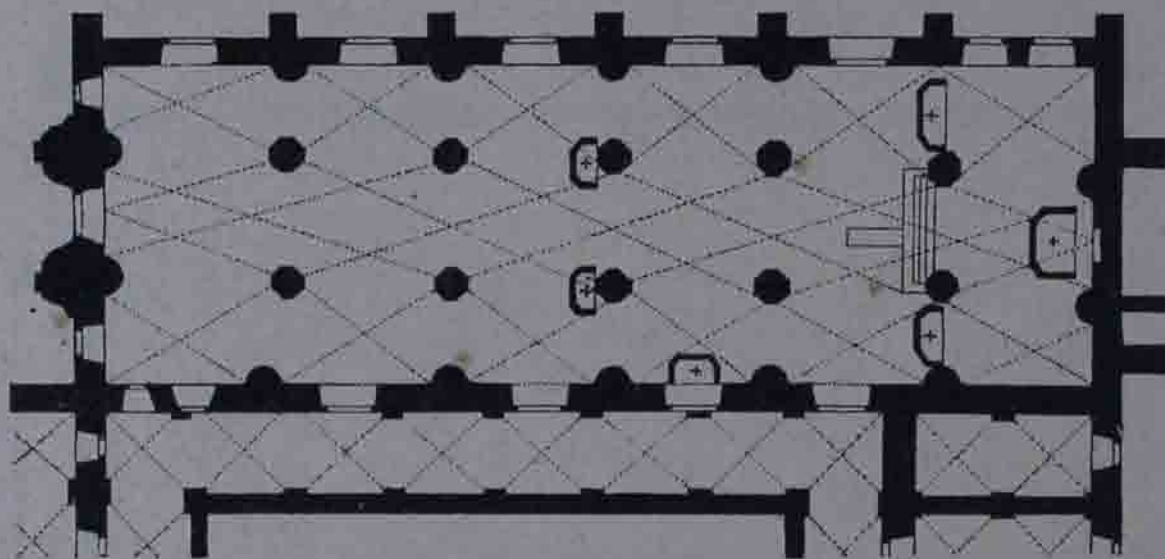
Tulln, ehemalige Dominikanerinnenkirche; Grundriß.
